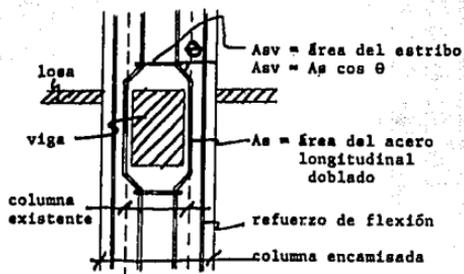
Continuidad del acero de la columna a través del sistema de piso.
